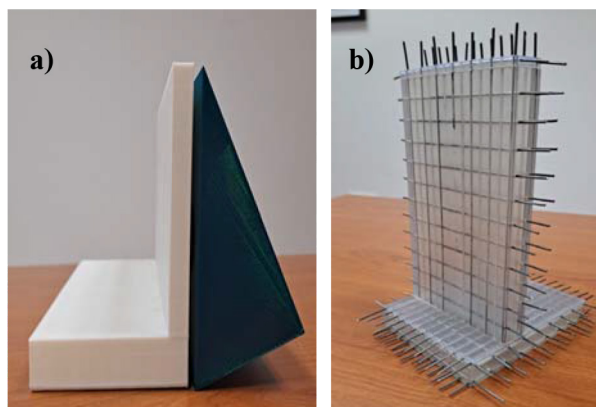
Maquetas sobre empujes (a) y sobre armaduras (b) en muros de construcción
